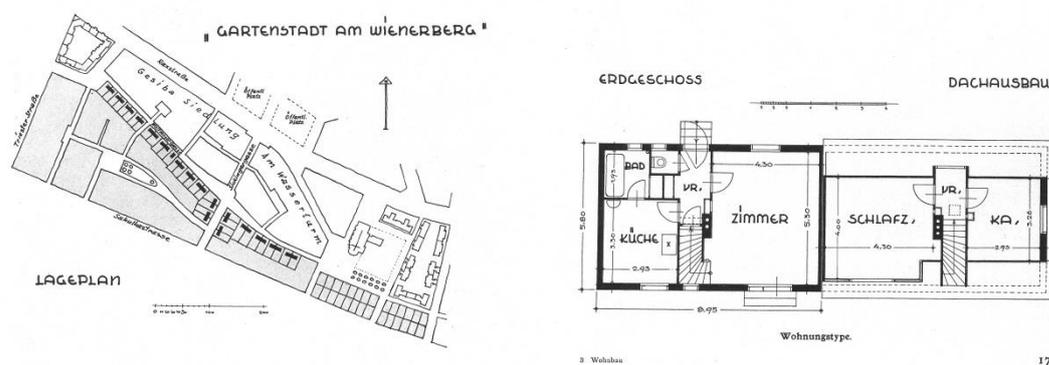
Lageplan und Grundriss einer Haustype der Gartenstadt am Wienerberg
